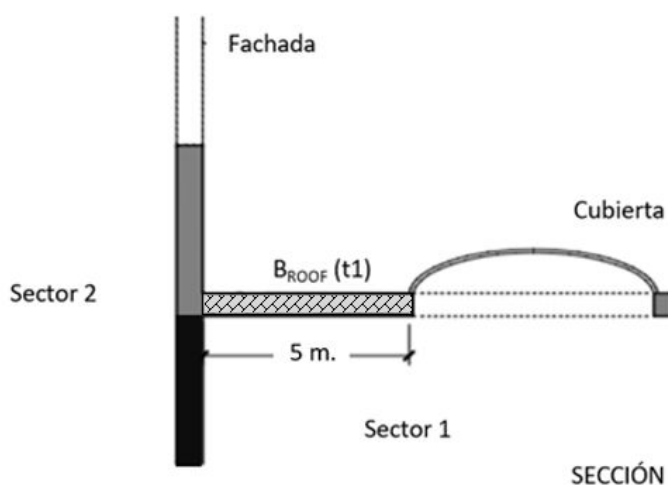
Reacción al fuego de la cubierta, en el encuentro cubierta-fachada.
